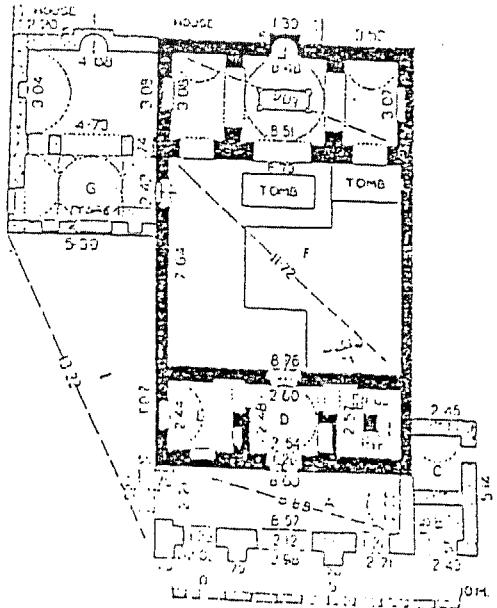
زيد، مسجد ومدرسة ابن الدبيع، المسقط الأفقي
